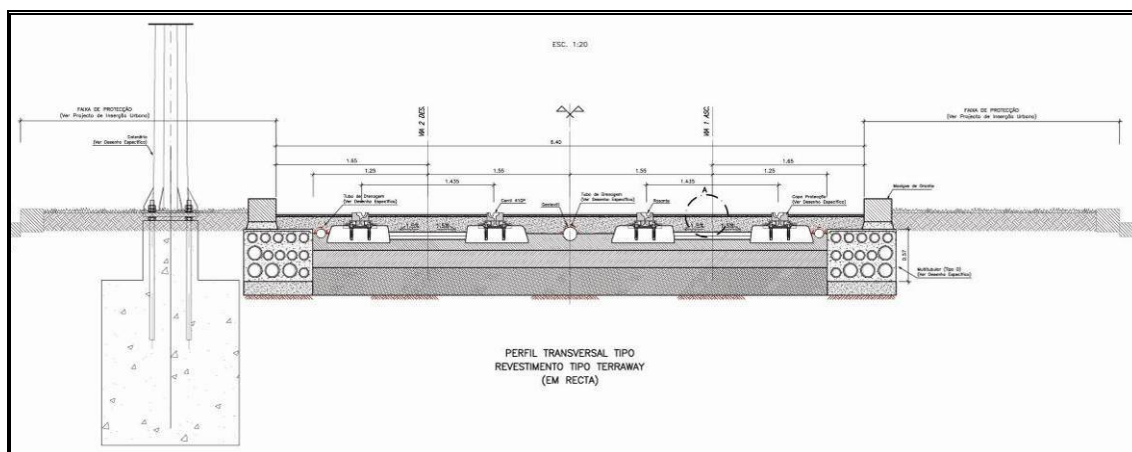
Perfil Transversal Tipo Revestimento Tipo Terraway
